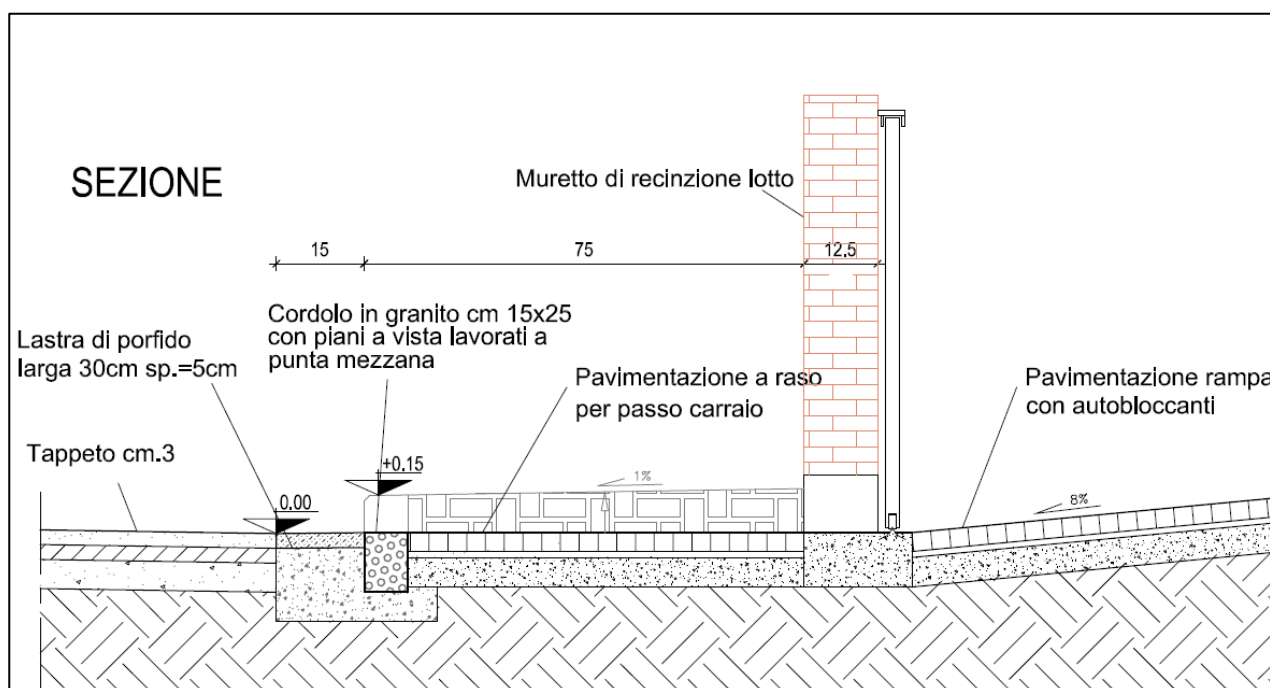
sezione raccordo marciapiede – sede stradale – accesso lotto privato
